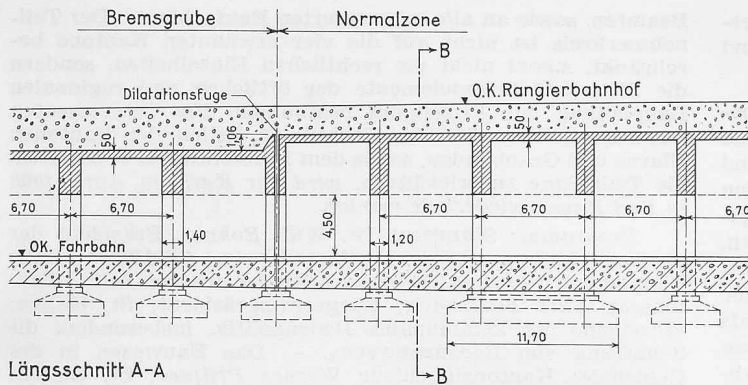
Autobahn-Galerie Schweizerhalle, Schnitte 1:500. Man beachte die aussergewöhnlichen Abmessungen der Eisenbetonkonstruktion
